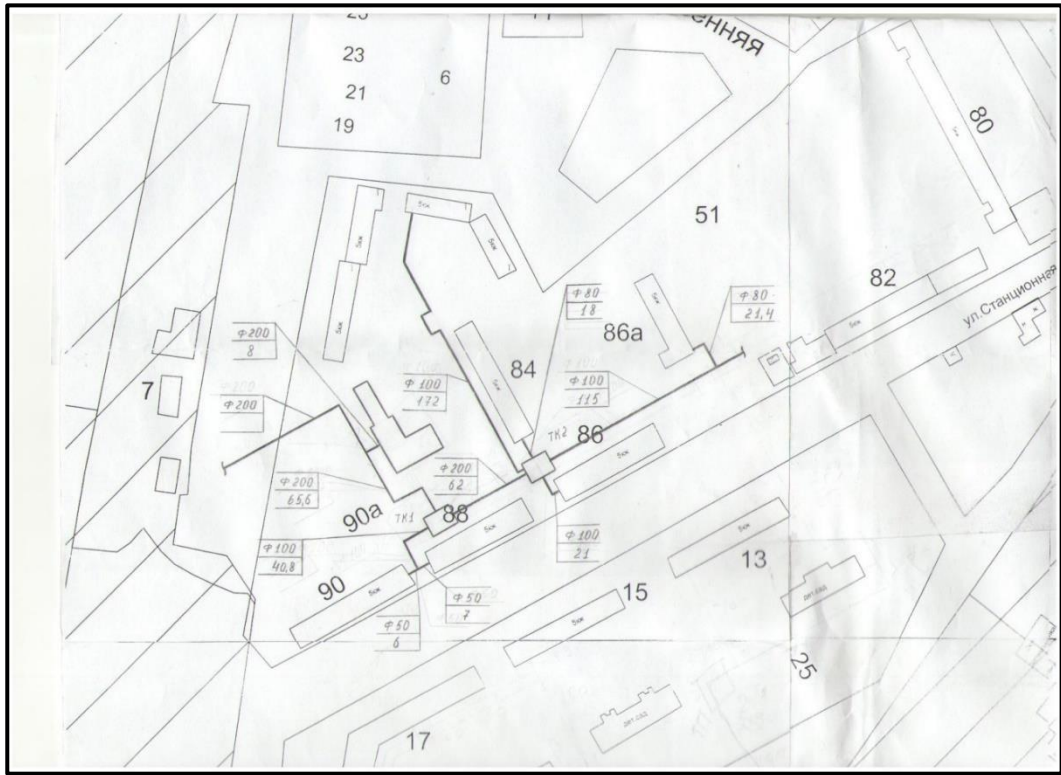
Бумажная схема тепловой сети от котельной «Квартальная»
